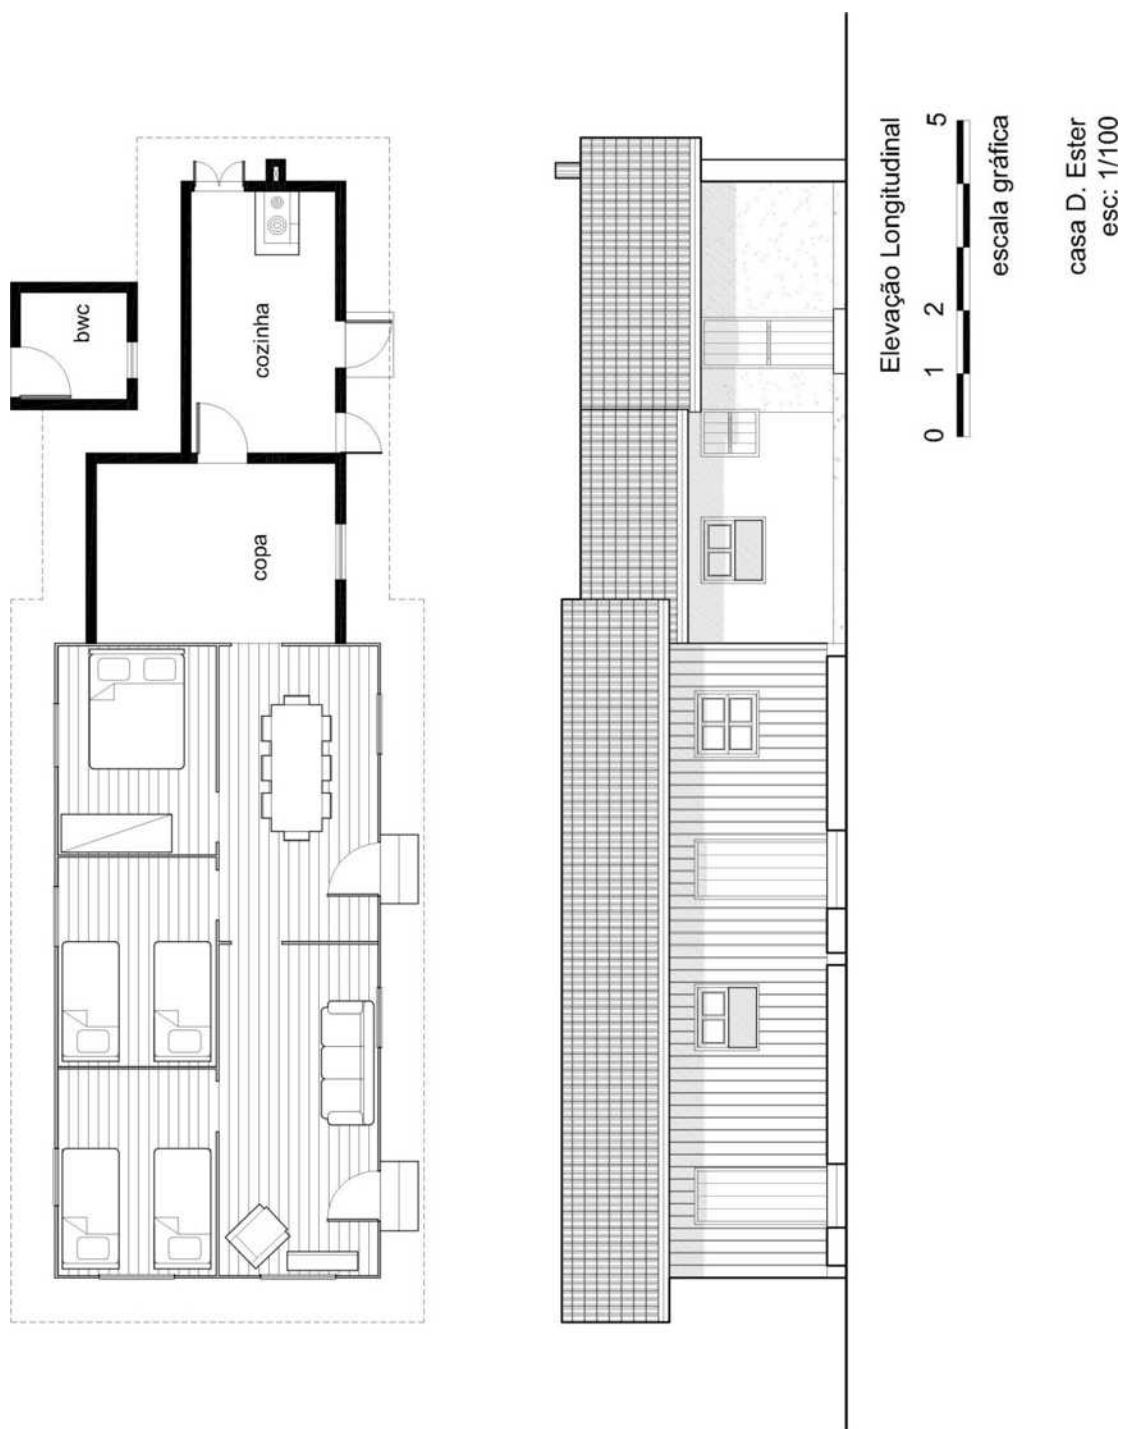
Casa da D. Ester – desenhos técnicos do levantamento.
